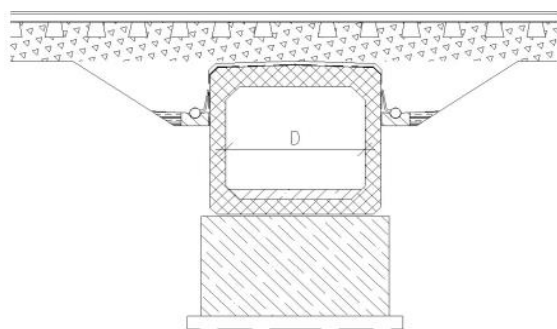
Exemplu de podeț realizat din cadre prefabricate din beton armat
